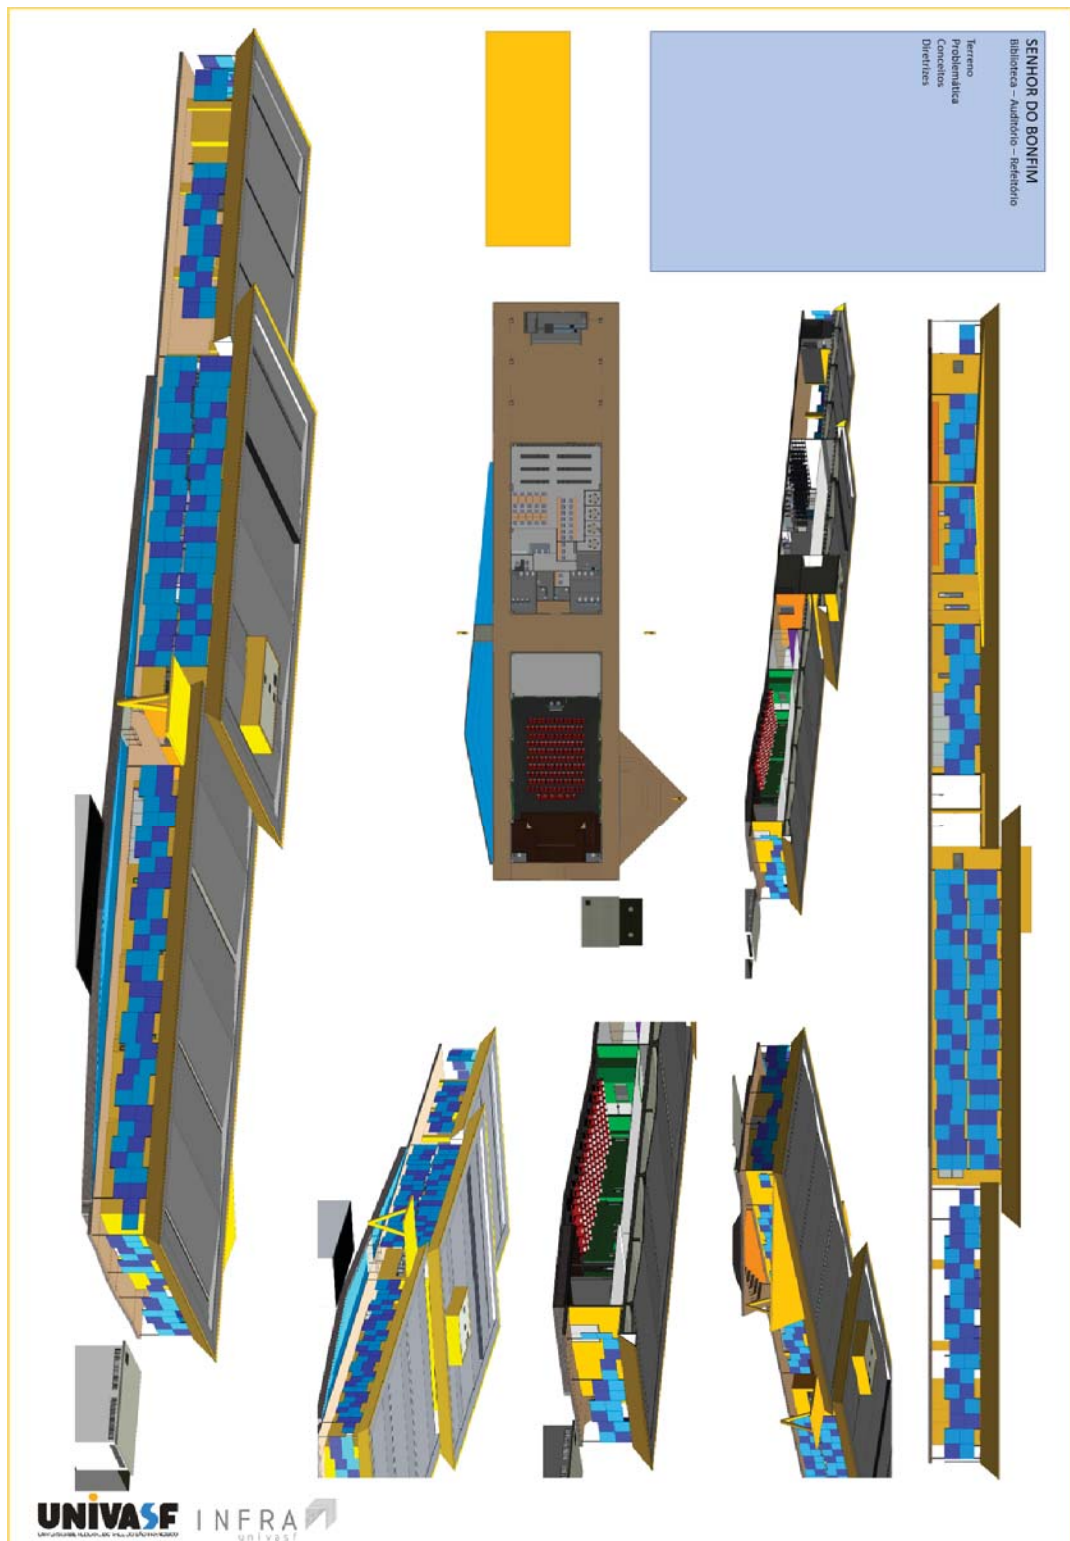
Planta baixa do pavilhão auditório, refeitório e biblioteca
